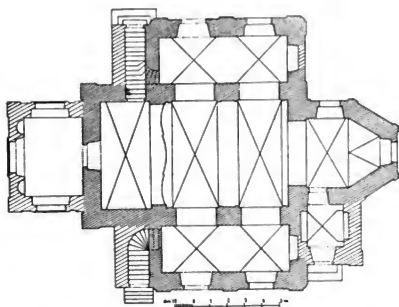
Miröschau. Grundriss der Sct. Josefskapelle.
